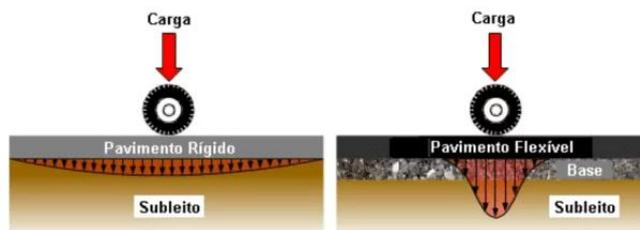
Comparação da distribuição de cargas do pavimento rígido e flexível.
